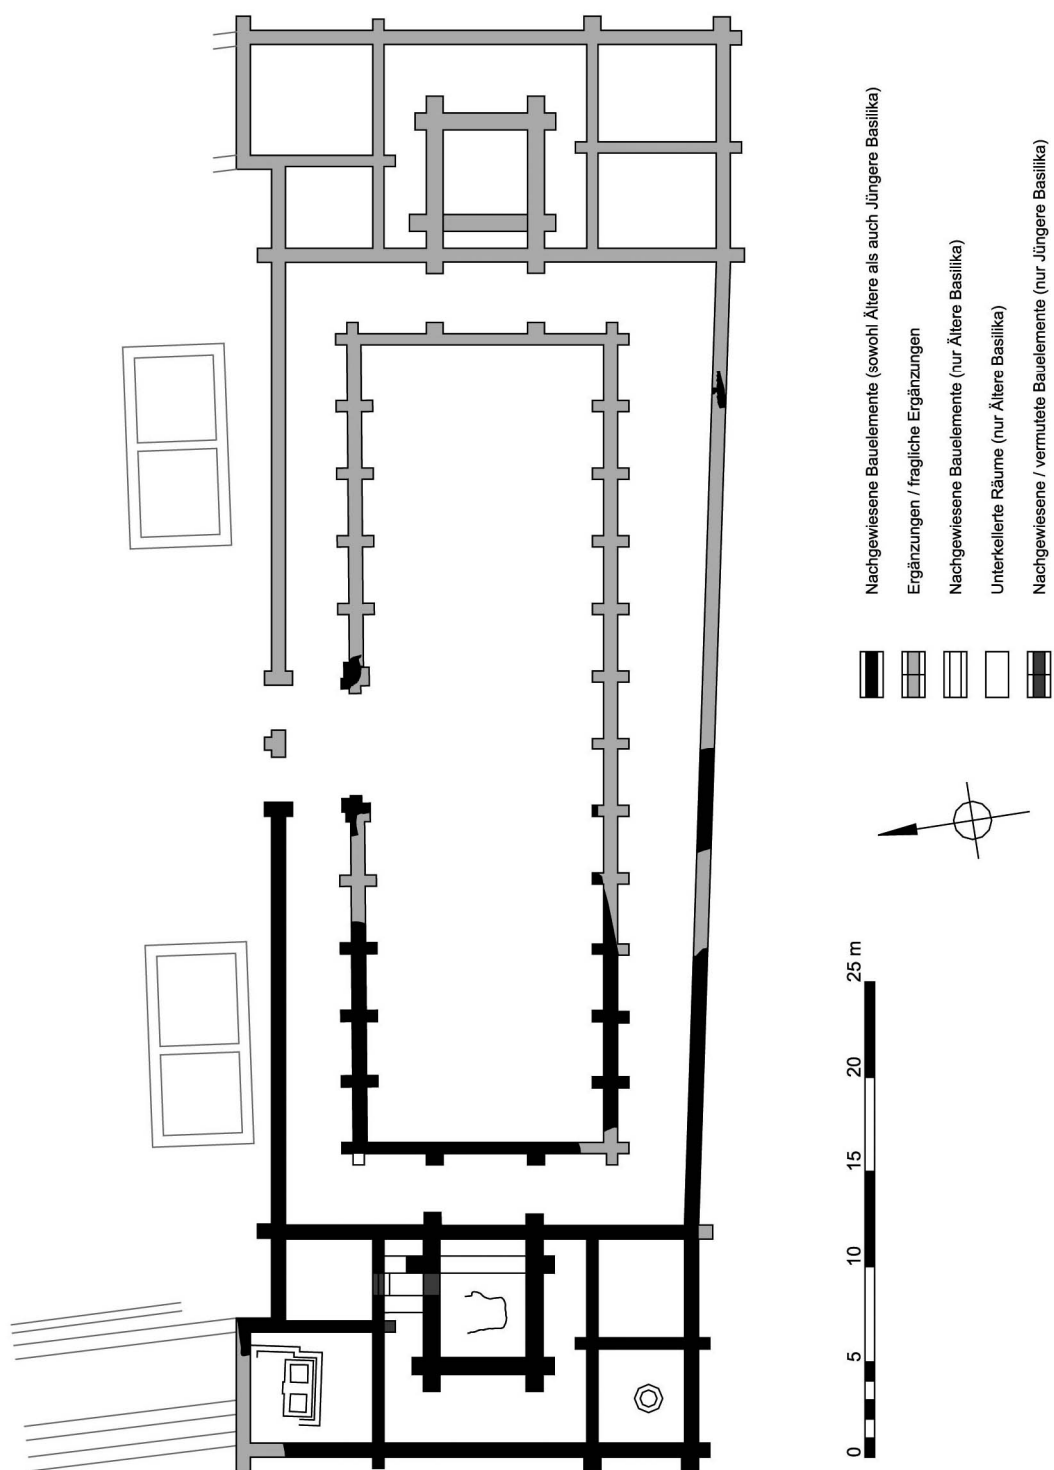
Rekonstruierter Grundriß der Riegeler Forumsbasilika im Fundamentbereich.
